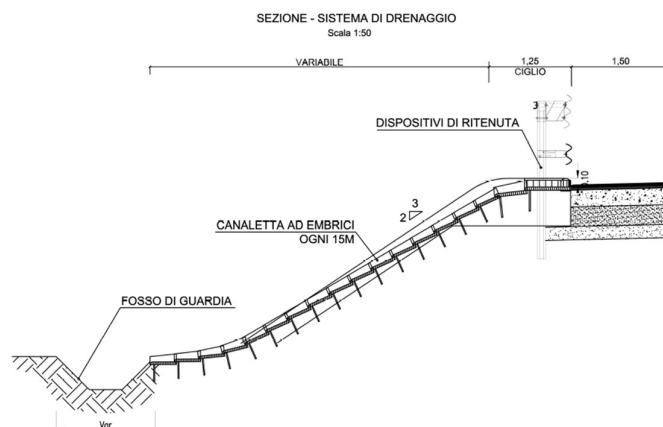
Tratto in rettilineo - drenaggio con embrici
